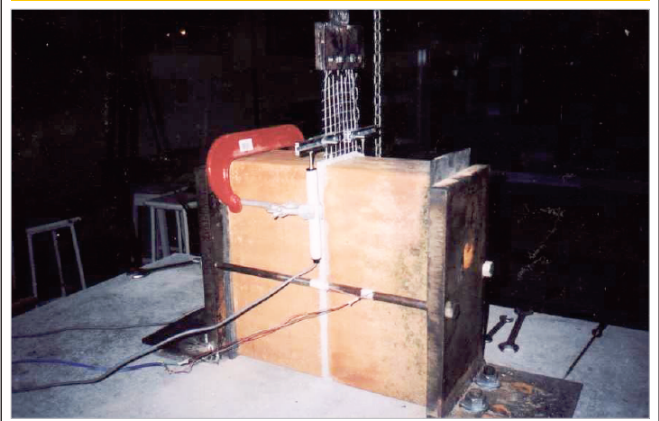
Arranjo de ensaio à tração dos modelos de tratamento de prevenção da fissura na ligação pilar/parede
